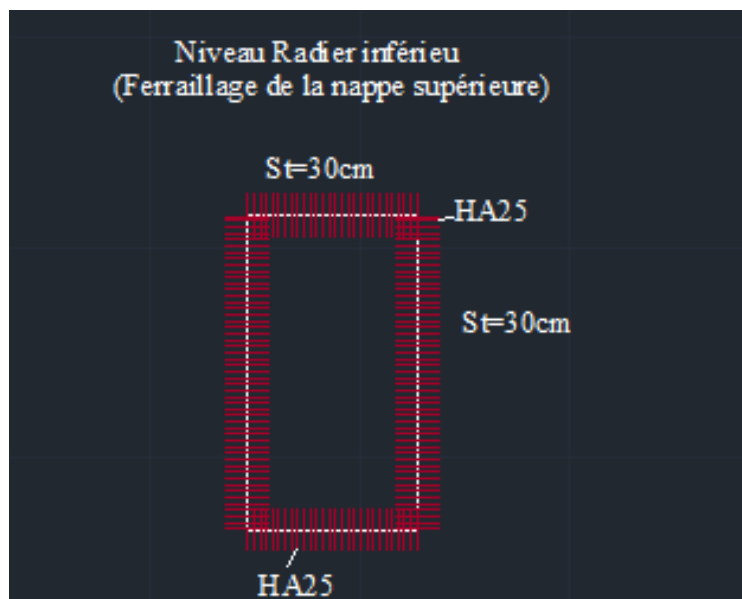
Schéma de ferrailage sur appuis du radier inférieur(Nappe supérieure)
